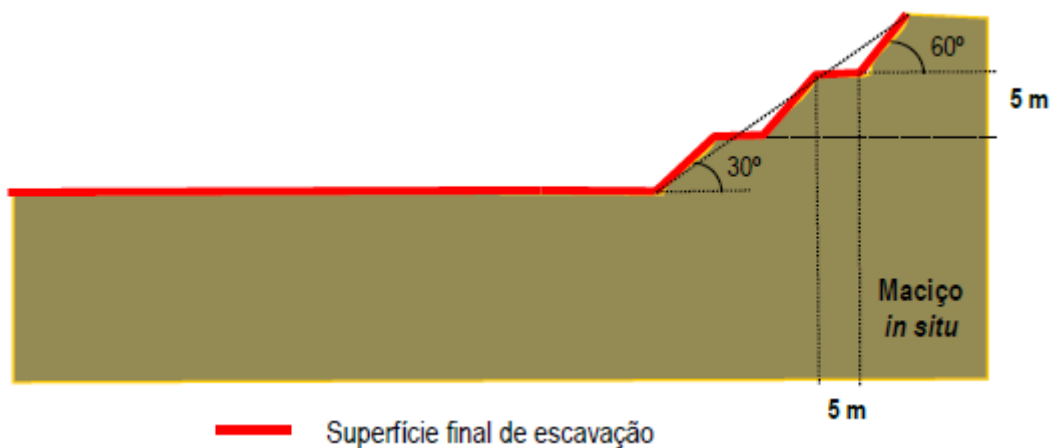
Perfil esquemático da configuração final da escavação (PP reformulado)
